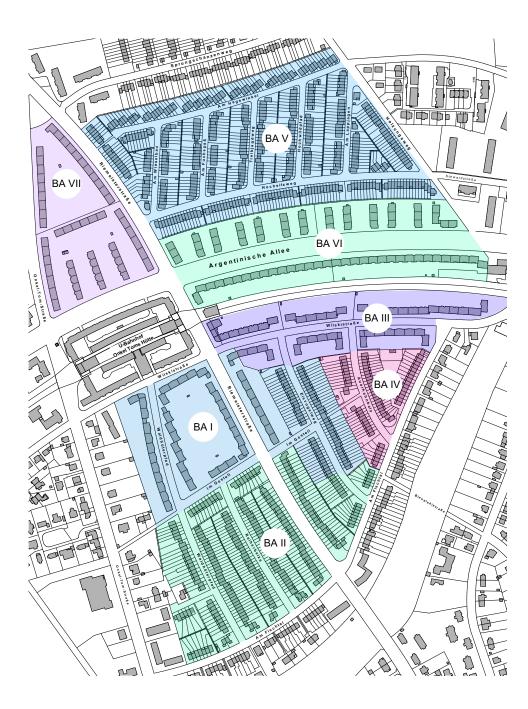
Lageplan der Waldsiedlung Zehlendorf mit den Bearbeitungsbereichen der drei Architekten.
